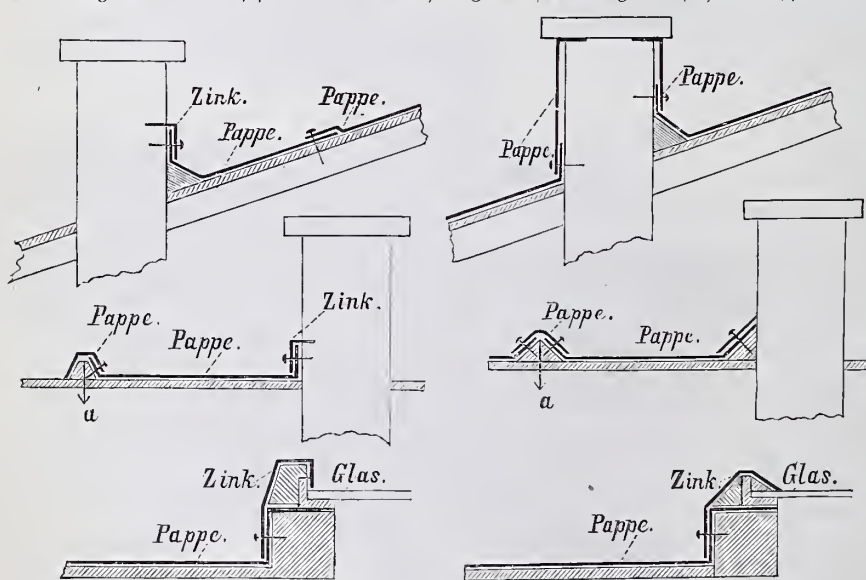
Dachpappendeckung, Andeckung an Eisen etc.
